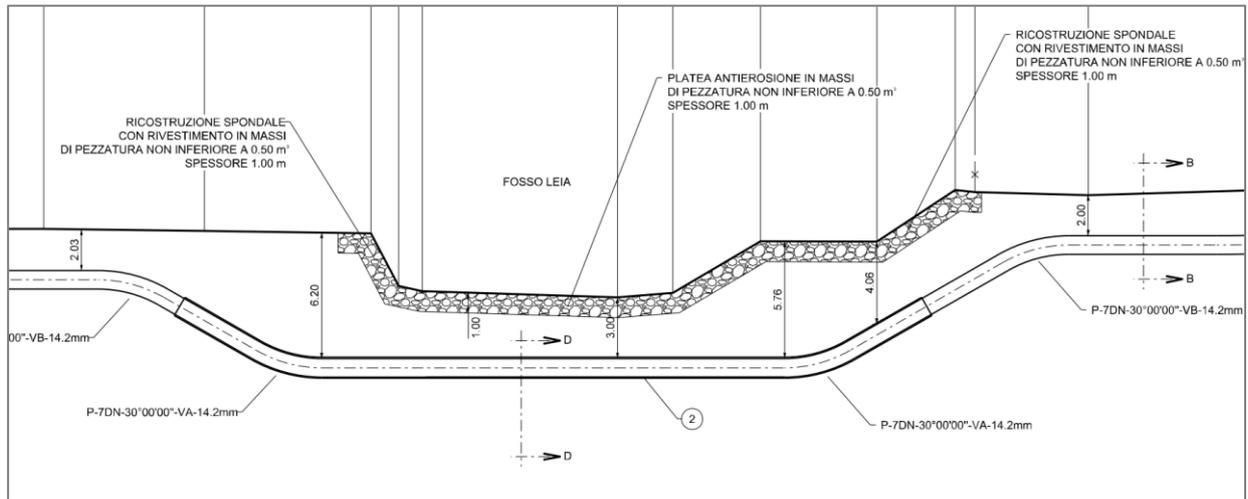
/C – Sezione tratto di alveo in corrispondenza dell'attraversamento
